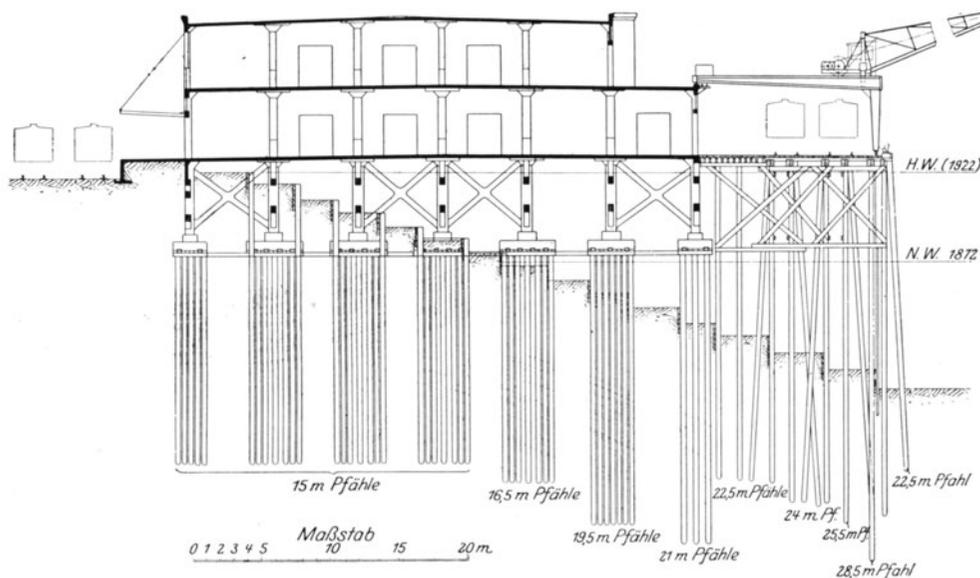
Zweistöckiger Beton-Kaispeicher auf der Böschung (Frontgebäude der Baumwollanlage).
